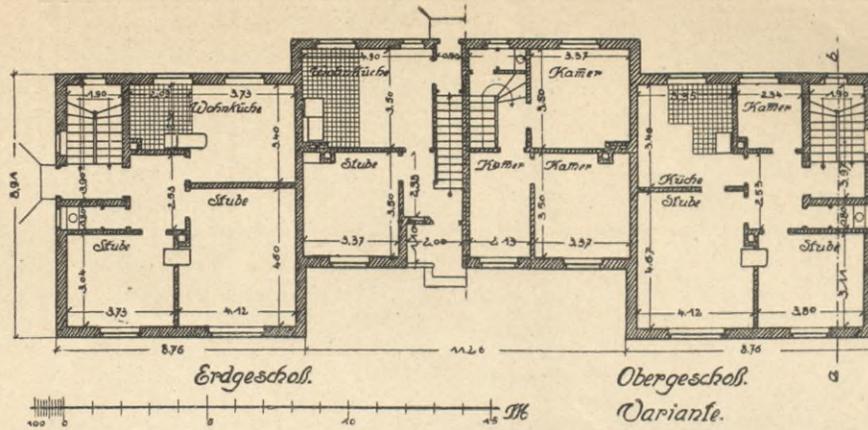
Typisches dreigeschossiges Sechsfamilienhaus in Sachsen (freistehend oder eingebaut)
